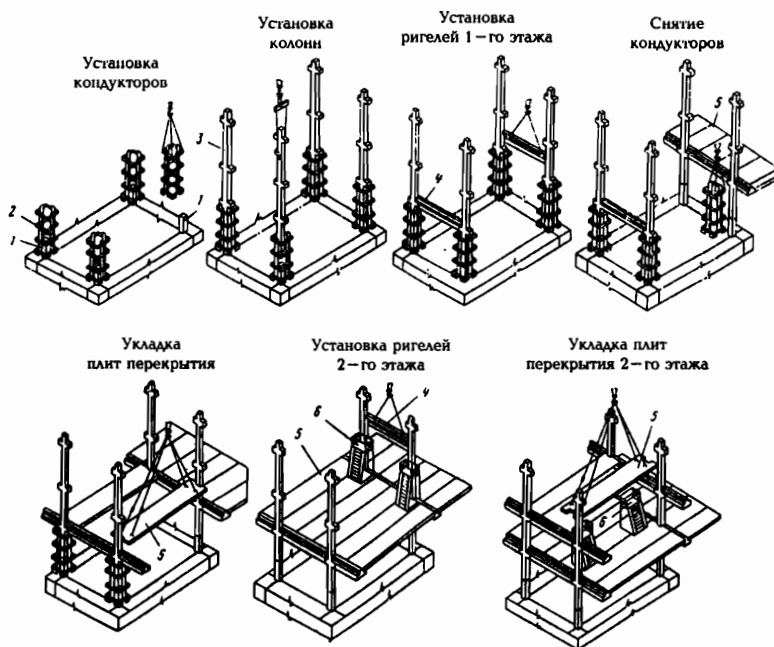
Монтаж элементов каркаса с многоэтажными колонками с применением одиночных кондукторов конструкции ЦНИИОМТП: 1 - оголовок нижестоящей колонны; 2 - кондуктор; 3 - многоэтажная колонна; 4 - ригель; 5 - плита перекрытия; 6 - монтажная площадка
